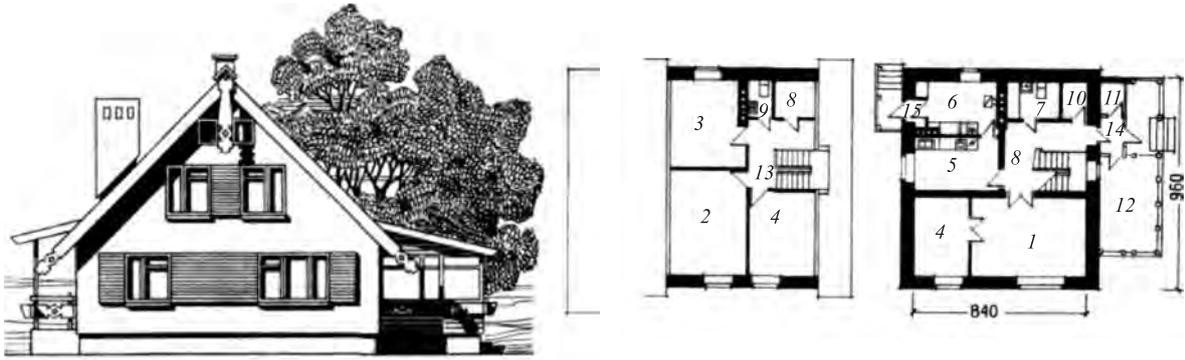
Мансардный одноквартирный пятикомнатный жилой дом. Типовой проект. Фасад, план мансарды, план первого этажа: 1— общая комната; 2—4 — спальные комнаты; 5 — кухня; 6 — рабочая комната; 7 — санузел; 8— прихожая; 9 — туалет; 10, 11 — хозяйственная, кладовая и шкафы; 12 — веранда; 13 — коридоры; 14, 15 — тамбуры
